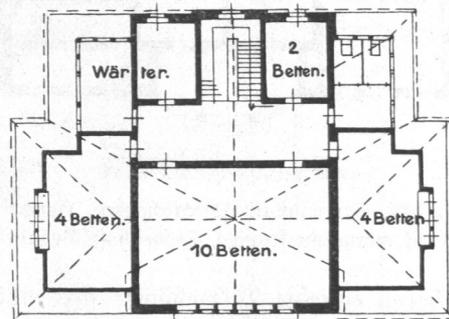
Irrenanstalt Friedrichsberg, Männerhaus für Genesende, Obergeschoß, Grundriß.
